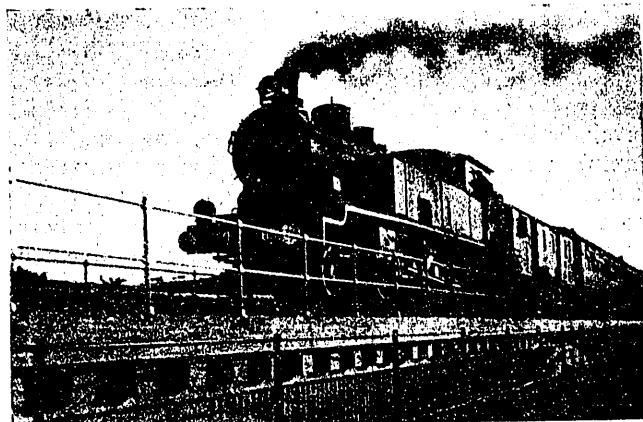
El primer tren que pasó sobre el puente, al llegar al apeadero que existe a la salida de aquí.
